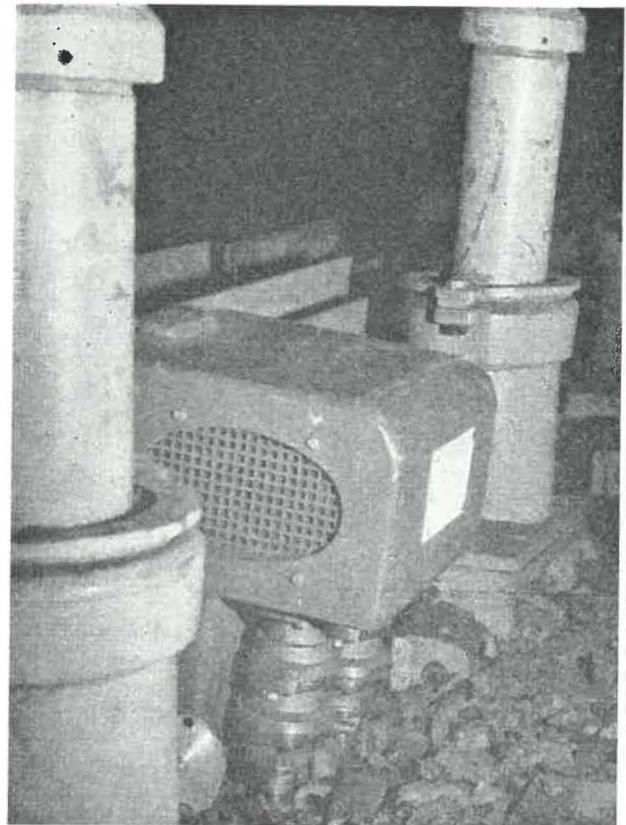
Gros plan d'un coffret de section fixée aux hausses.
